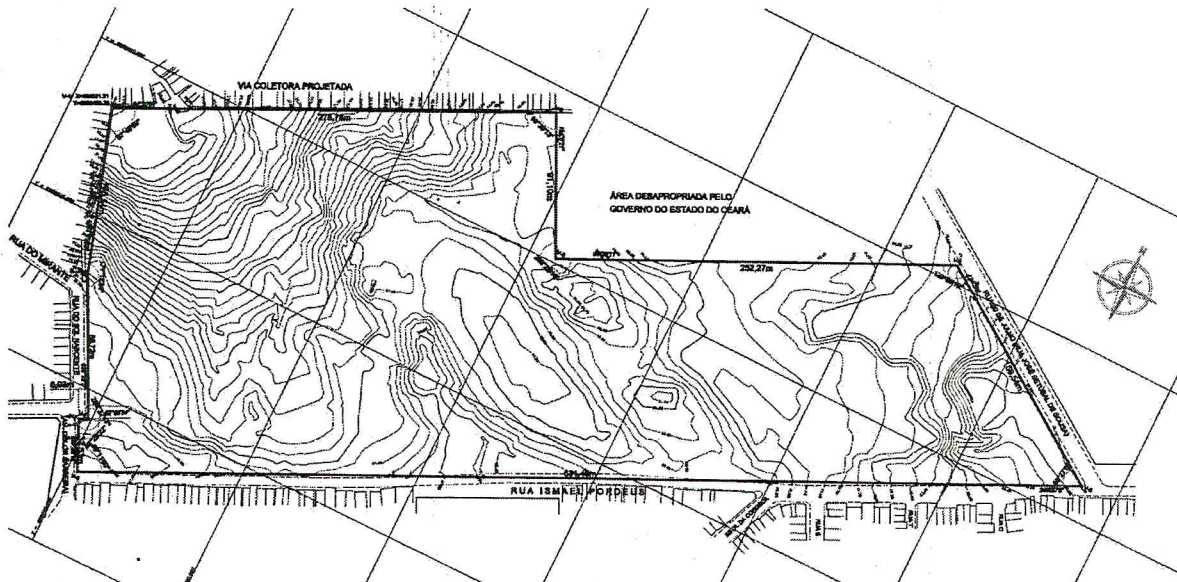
Morro Santa Terezinha - Levantamento Planialtimétrico do Loteamento Residencial Alto da Paz.
